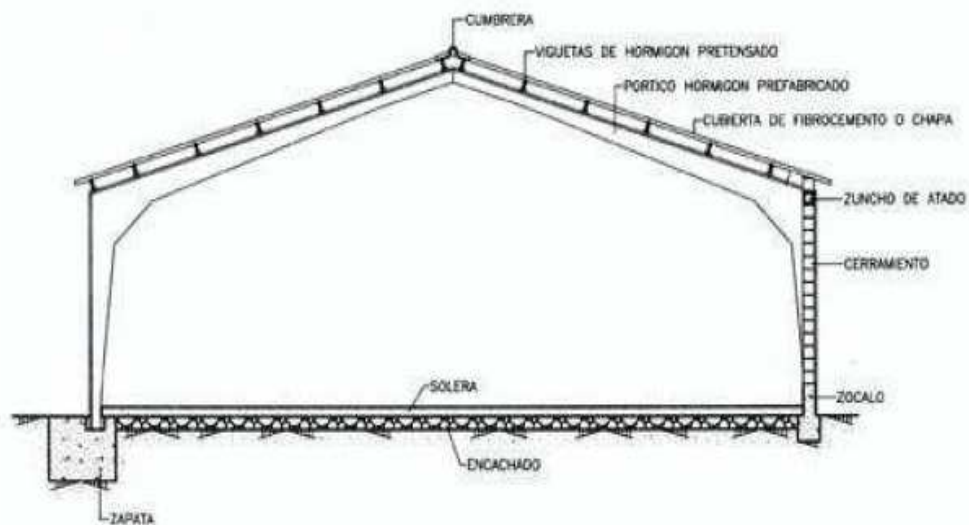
Estructura con pórtico prefabricado de hormigón “2 piezas”.
